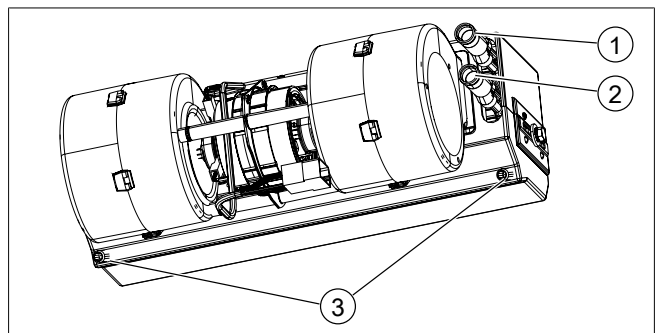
Kühlmittel- und Ablaufanschlüsse
